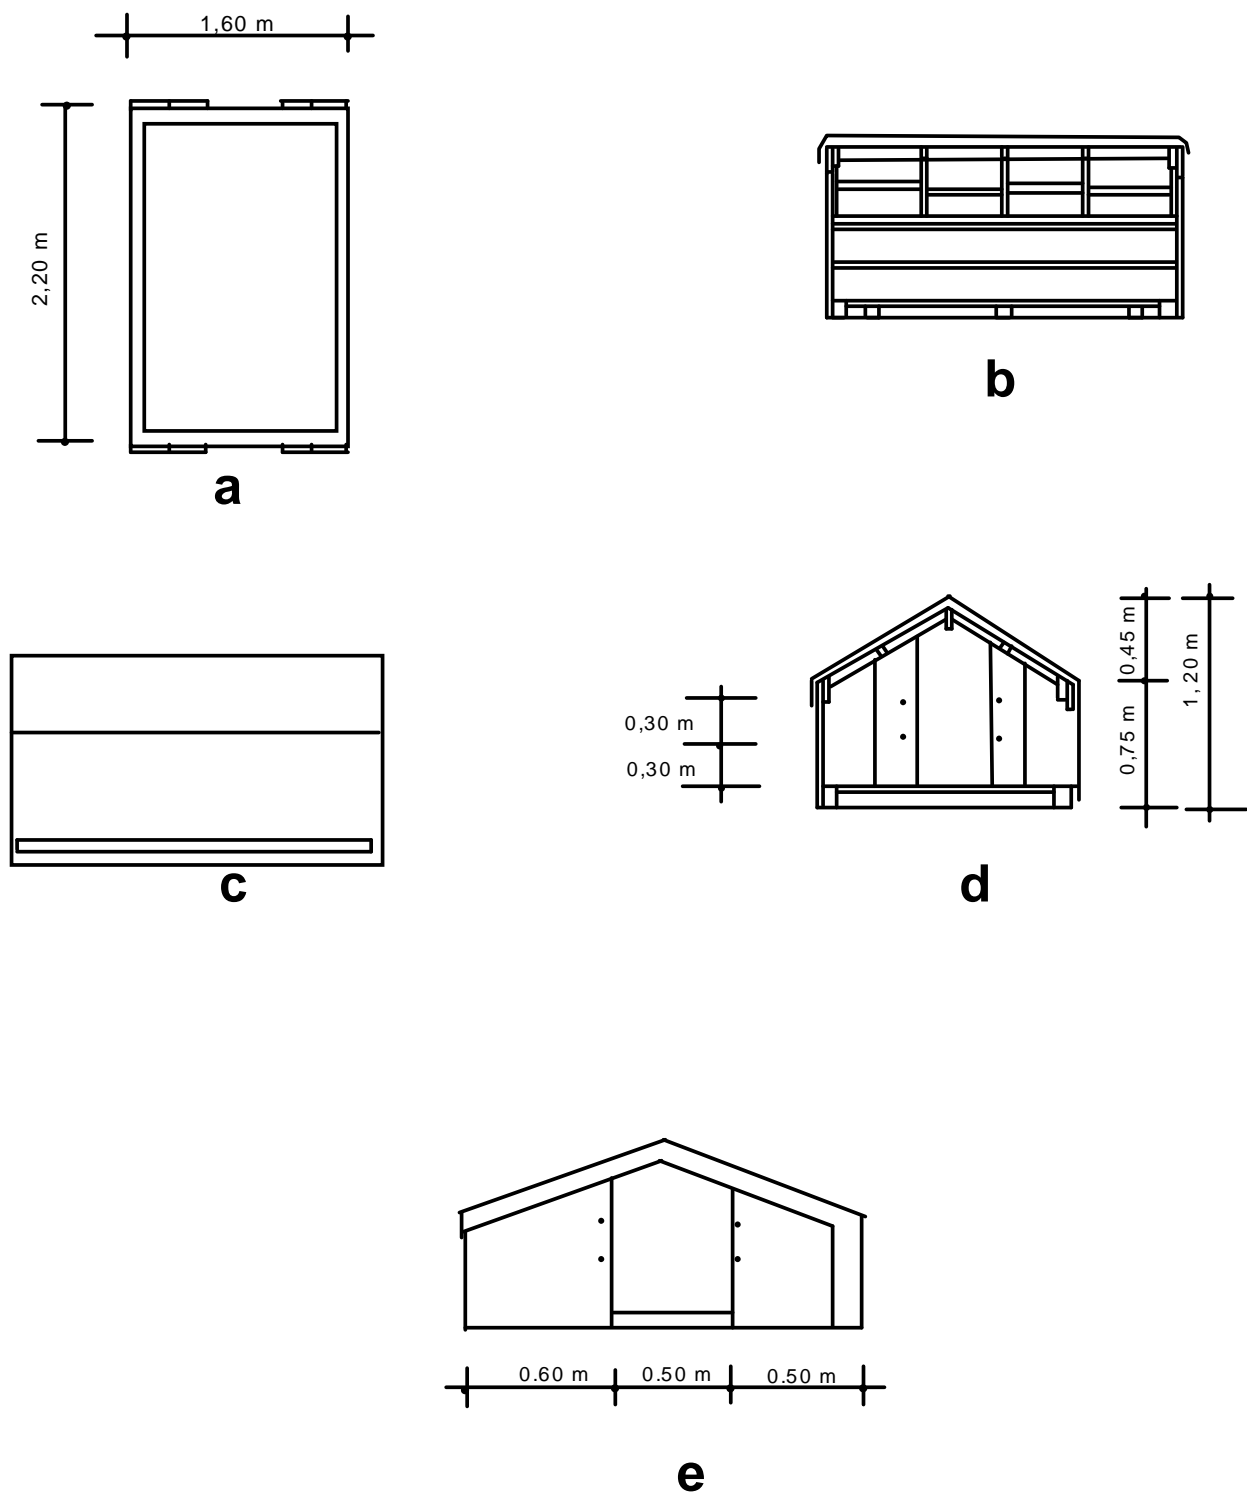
Cortes: a) Planta baixa; b) Corte longitudinal; c) Corte transversal; d) Fachada lateral; e) Fachada frontal.
